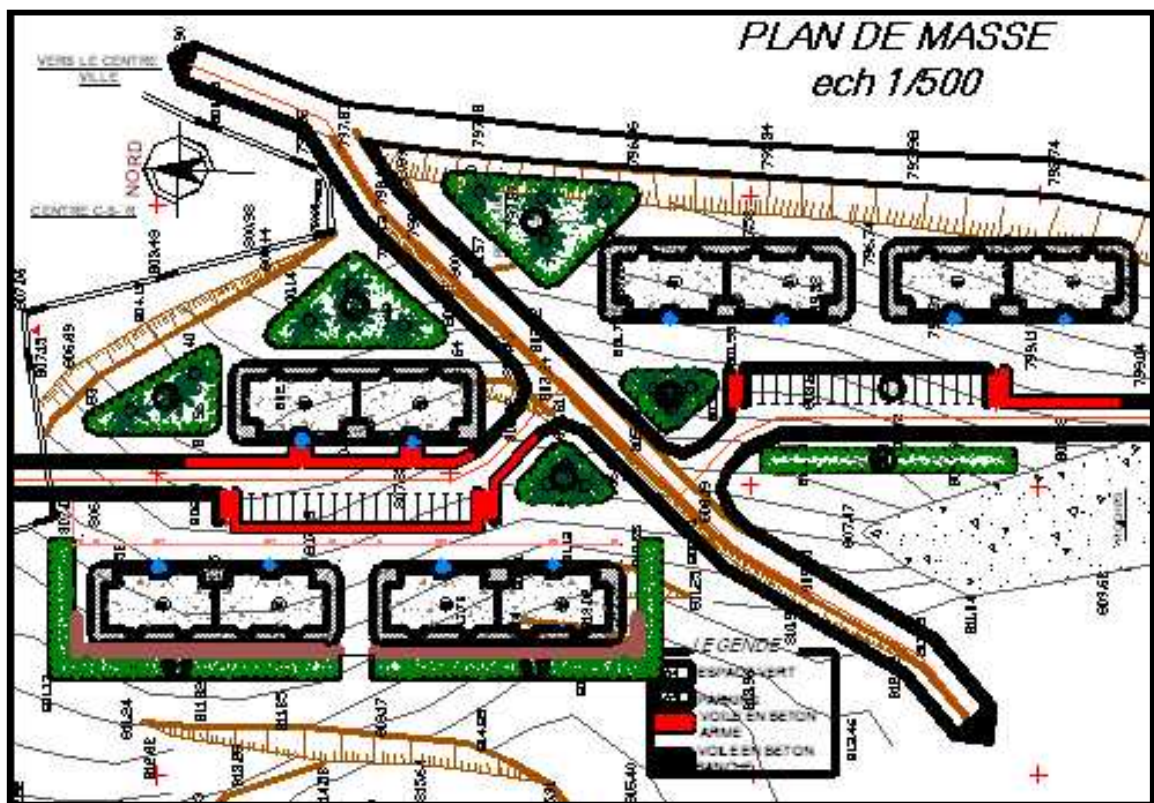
plan de masse du 3^{ème} cas d'étude. (Source bureau d'étude)
